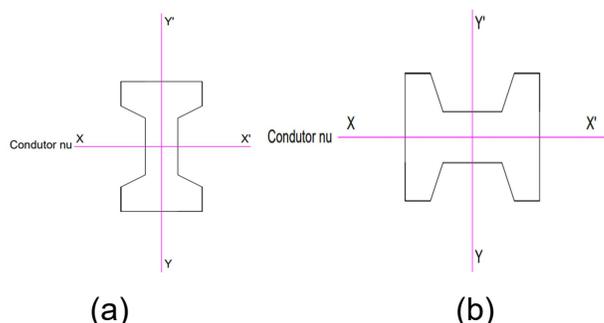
Implantação de apoio (a) normal (b) para reforço
